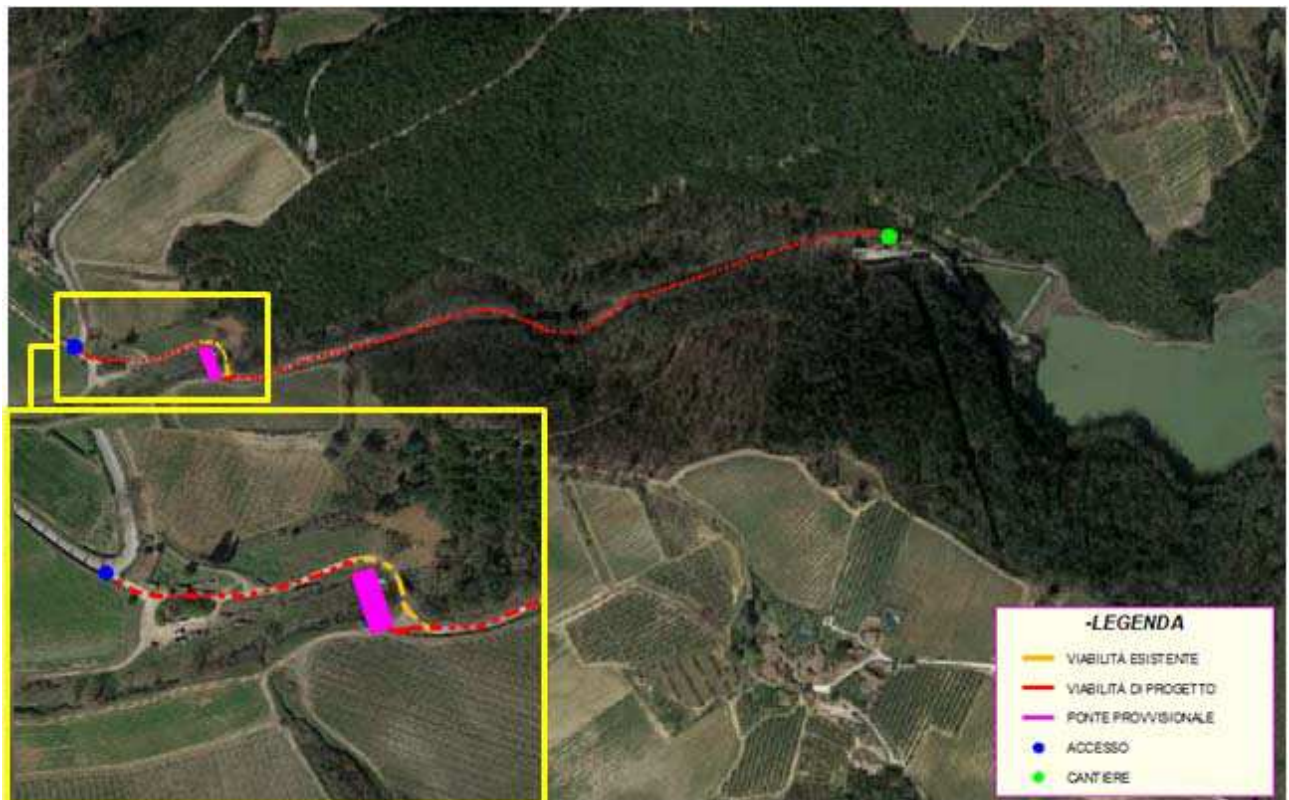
Viabilità esistente e di progetto per l'accesso all'area di cantiere
